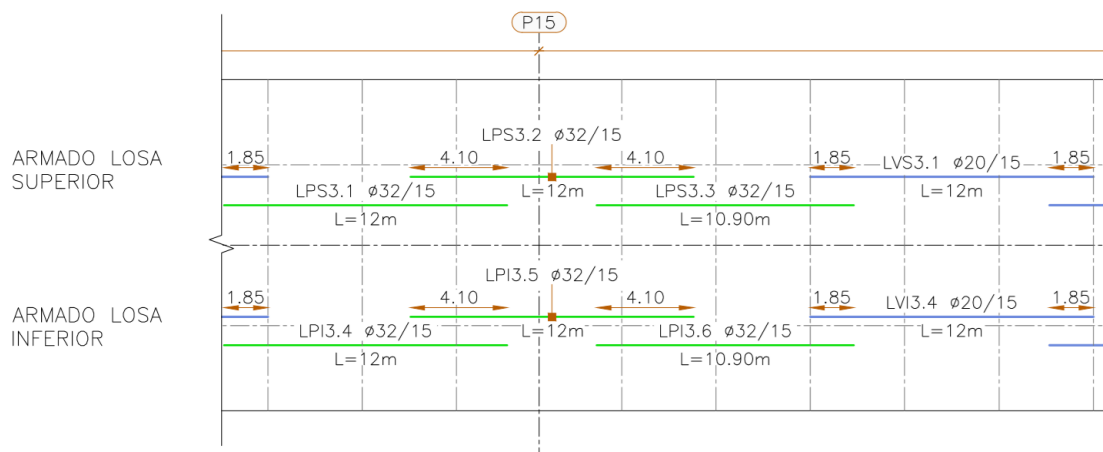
Distribución de las armaduras. Fuente: Proyecto de construcción de plataforma del corredor mediterráneo de Alta Velocidad Murcia – Almería.
